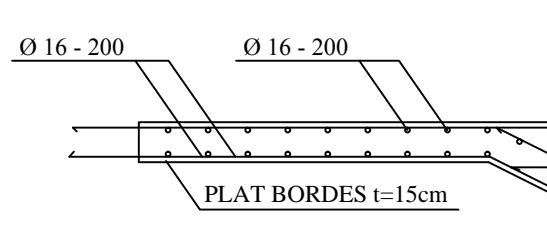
DETAIL POTONGAN TANGGA TYPE 2 BAGIAN KIRI
